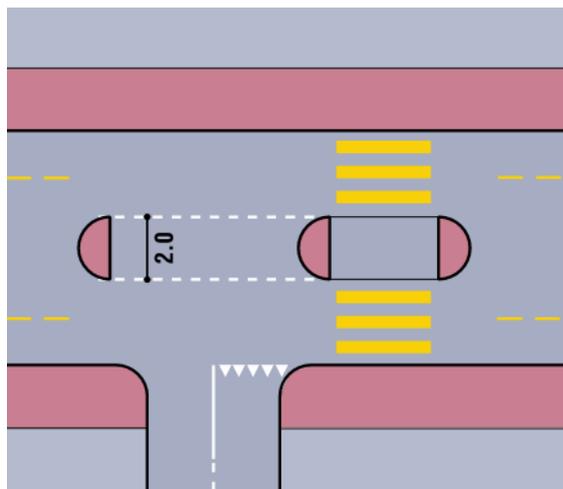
Exemple d'aménagement d'une intersection avec traversée piétonne sur une chaussée à voie centrale banalisée
